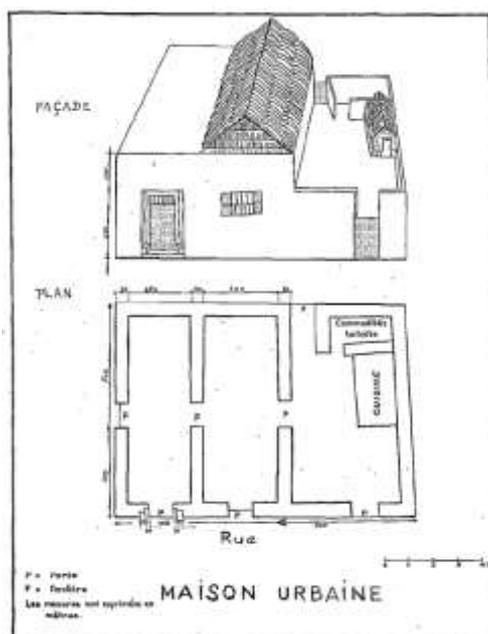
Maisons urbaine, façade et plan, d'après C. Robineau 1966a, p. 87.
